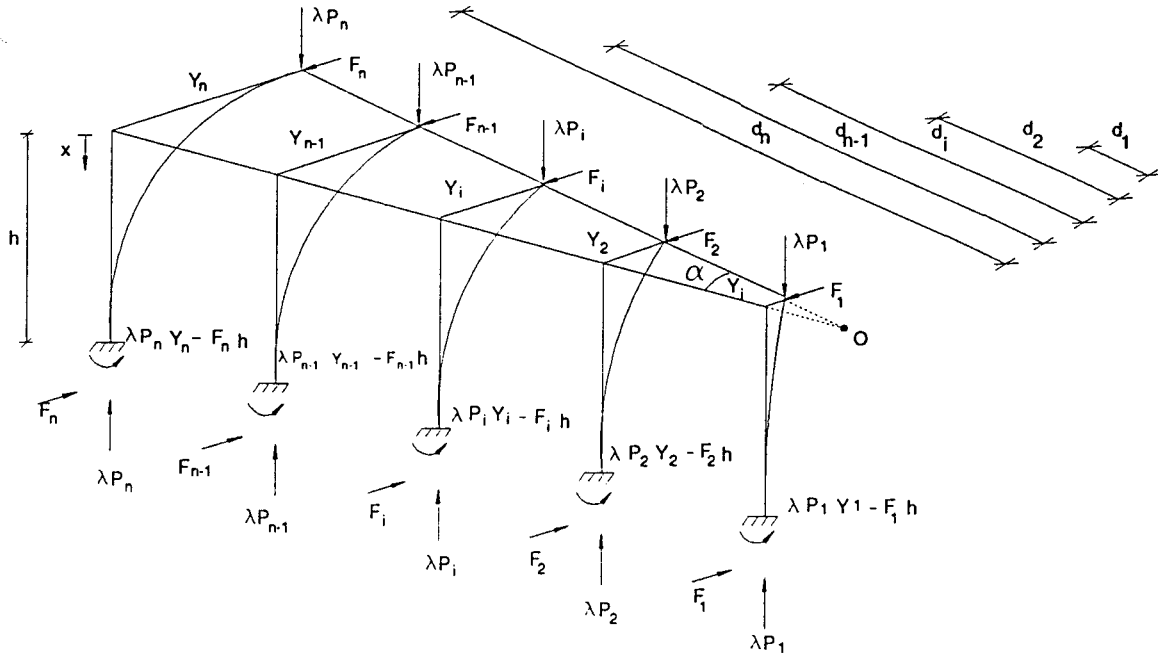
Estrutura plana - Forças envolvidas numa situação de instabilidade, desprezando a rigidez à torção dos elementos verticais.
